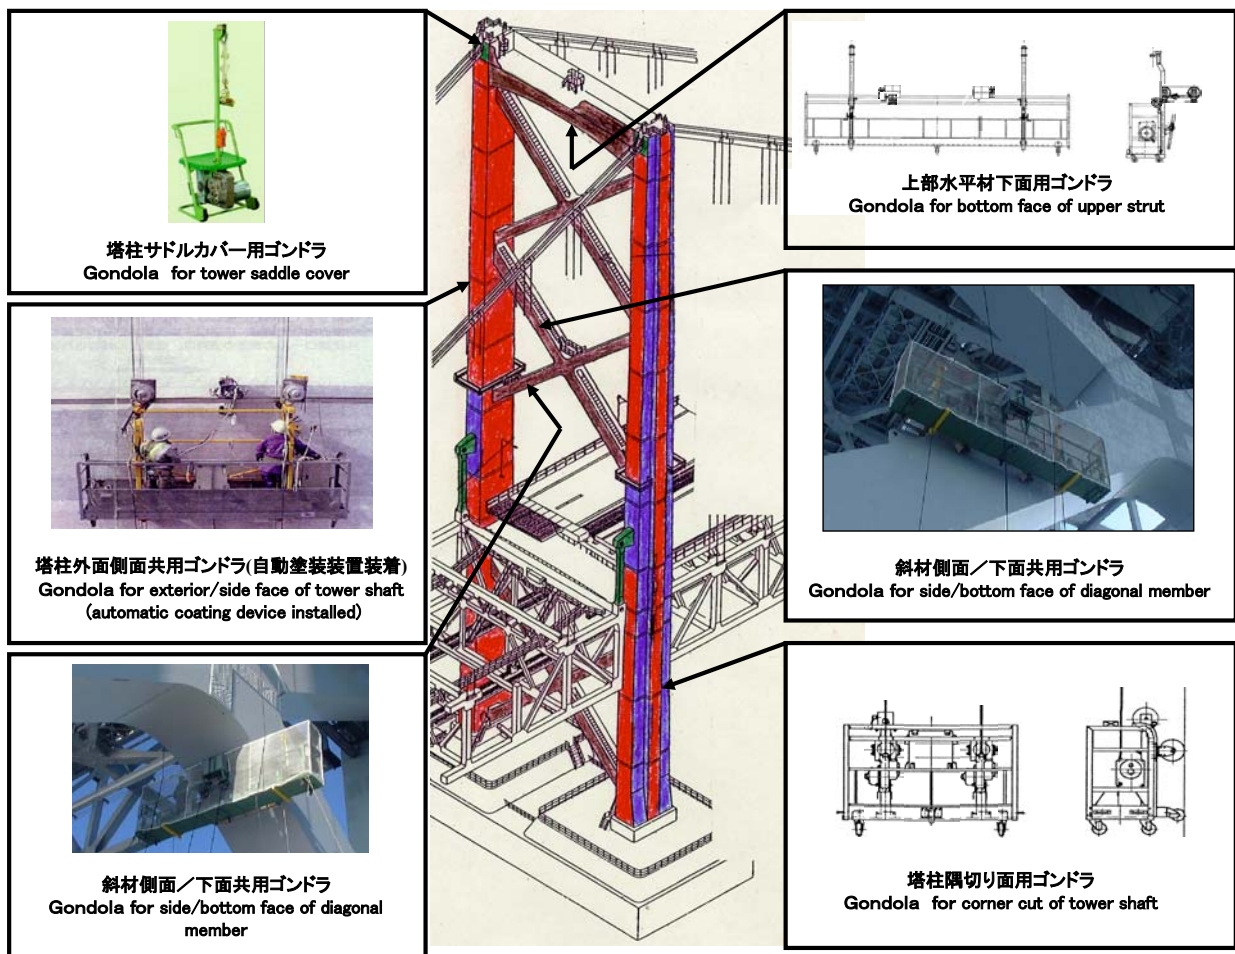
部位別施工状況 (Fig.1 Execution situation by site)
